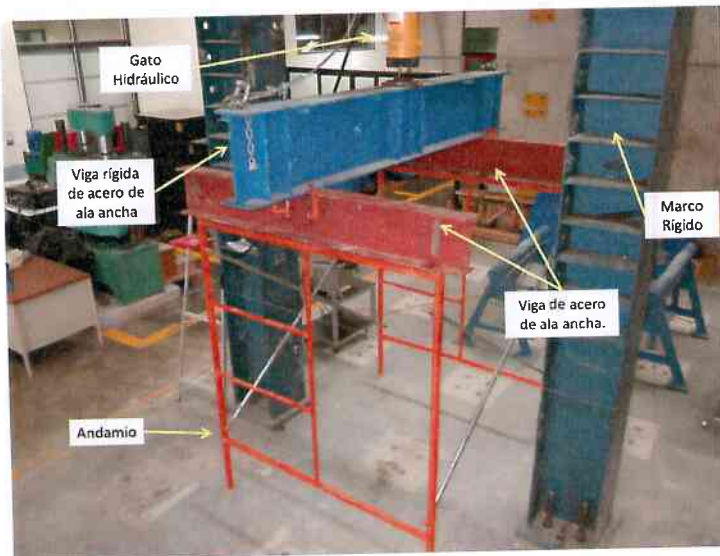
Fotografía del montaje utilizado en el ensayo de compresión en andamio.
